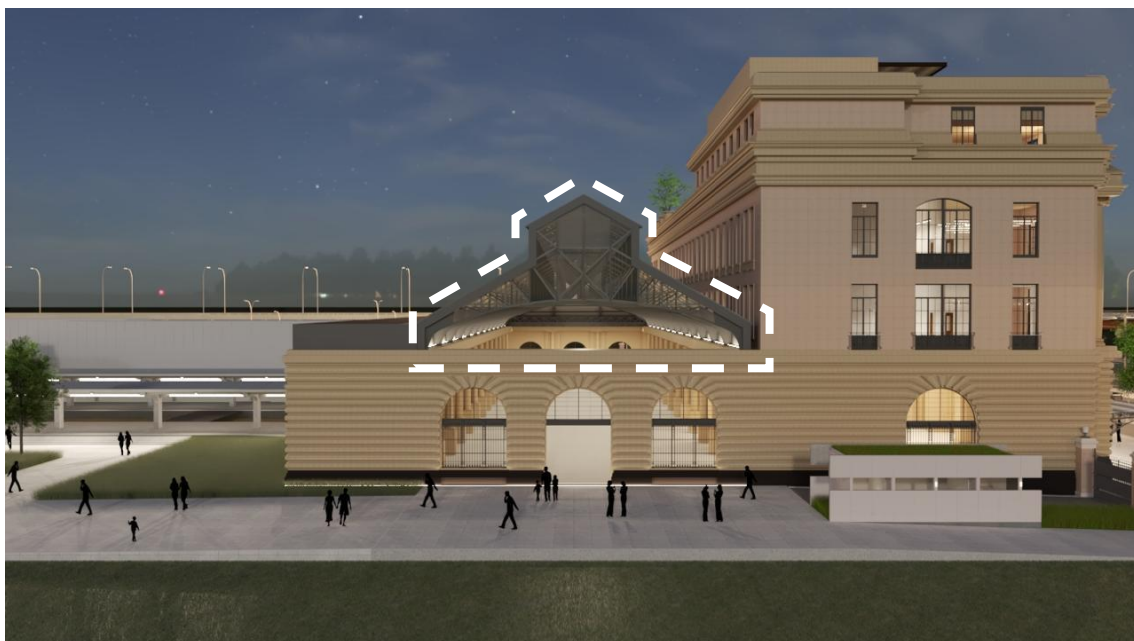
Esquadria em ferro e vidro proposta pelo projeto para finalizar a fachada sul do edifício.
